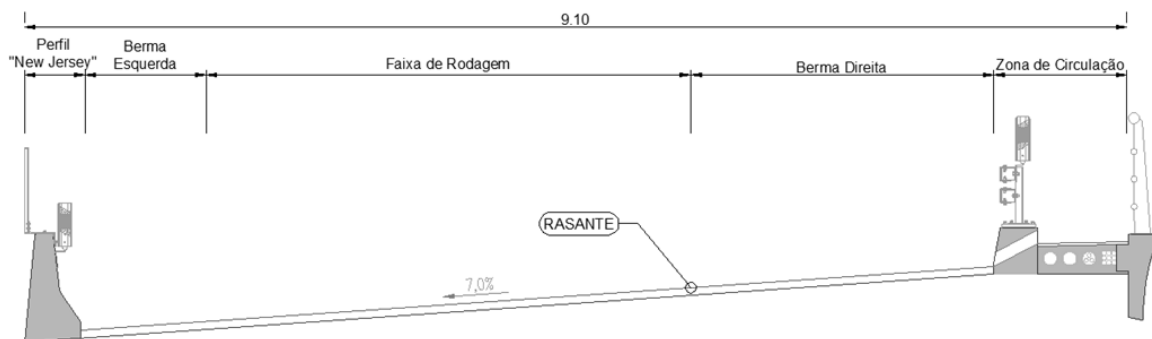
Perfil Transversal Tipo da Passagem Superior
